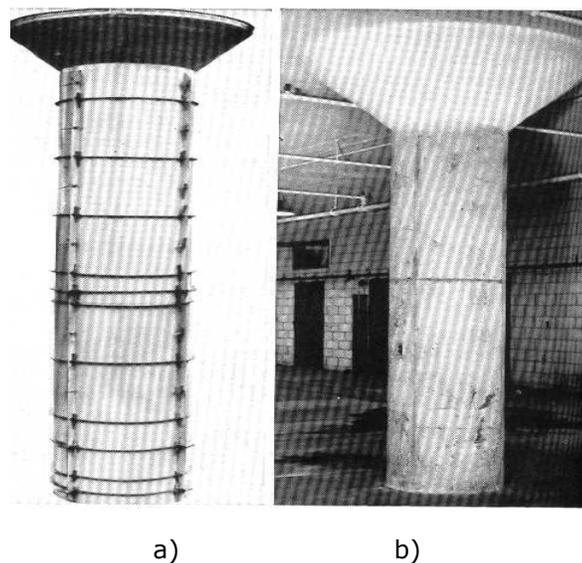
Fôrma para pilar com molde metálico: a) Fôrma montada; b) Pilar desformado (HURD, 1995).
